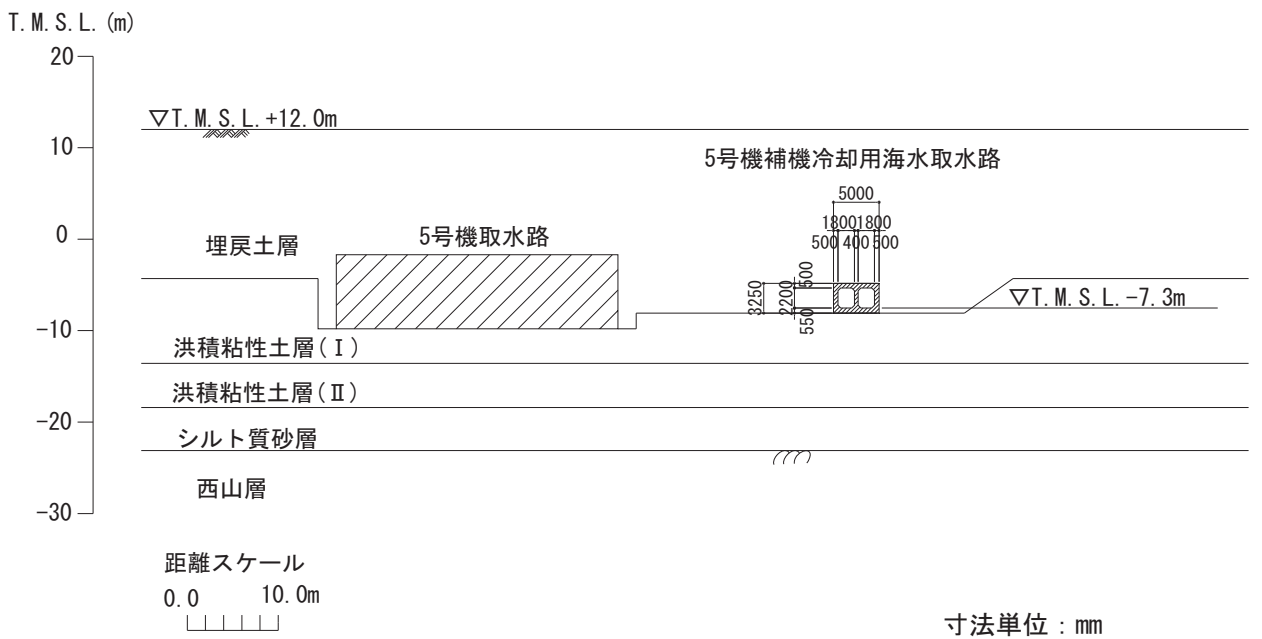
補機冷却用海水取水路断面図 (C-C断面)
